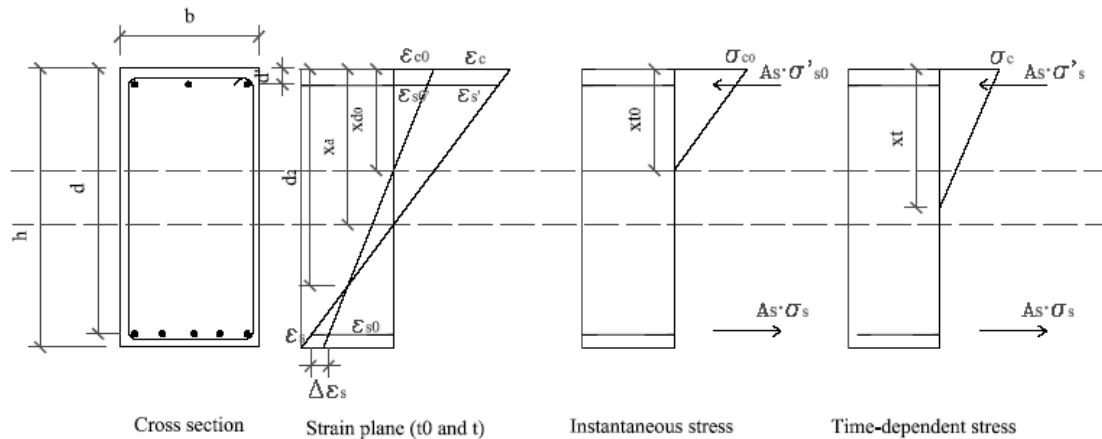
Plano de deformaciones y tensiones instantáneas y diferidas en una sección fisurada.
